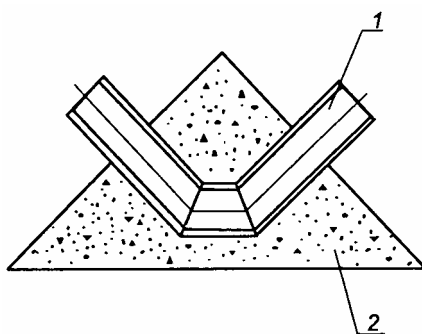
Разрез призматической бетонной неподвижной опоры по оси трубопровода на повороте трассы
